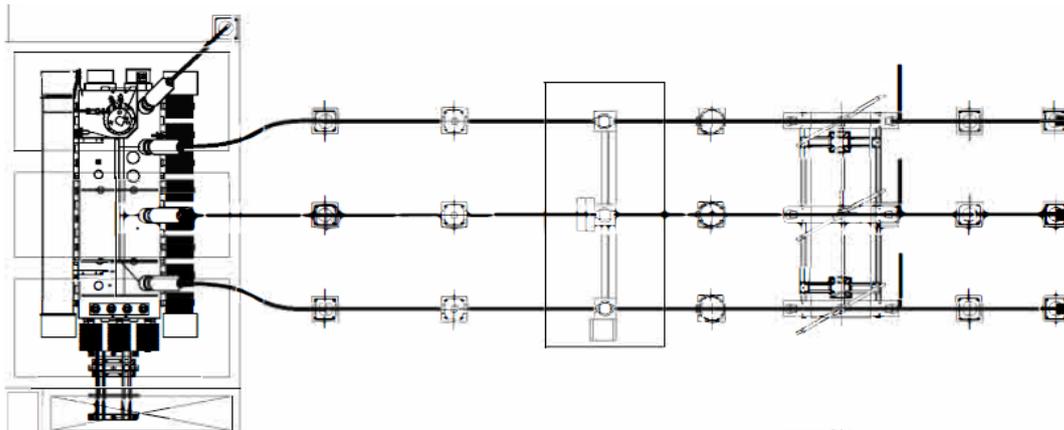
Pianta tipo Cabina Utente 150/30 kV
